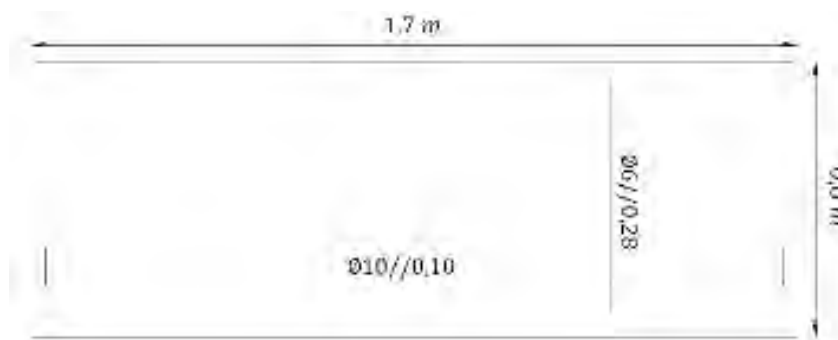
Disposição das armaduras das lajes ensaiadas (adaptado de Bandeira, 2006).
